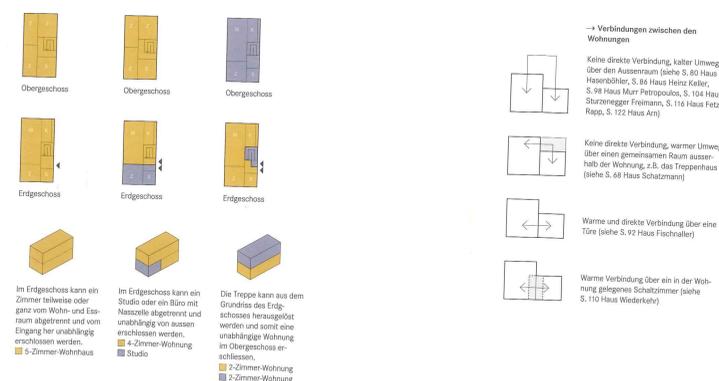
Ideen zur flexiblen Grundrissgestaltung
